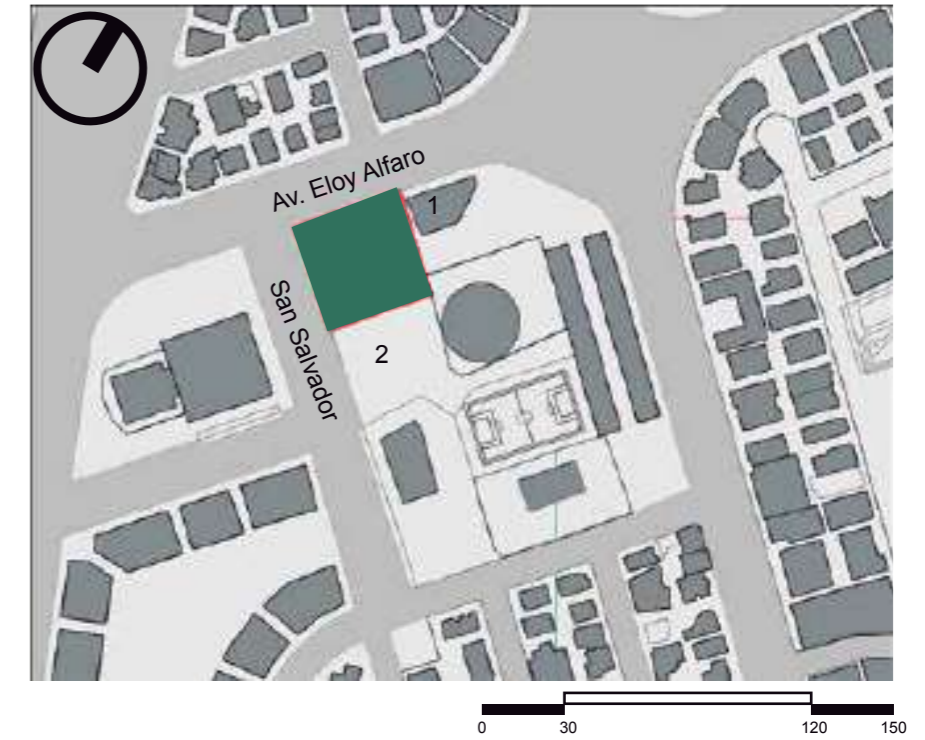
Conlindancias del terreno en planta, elaboración propia.
